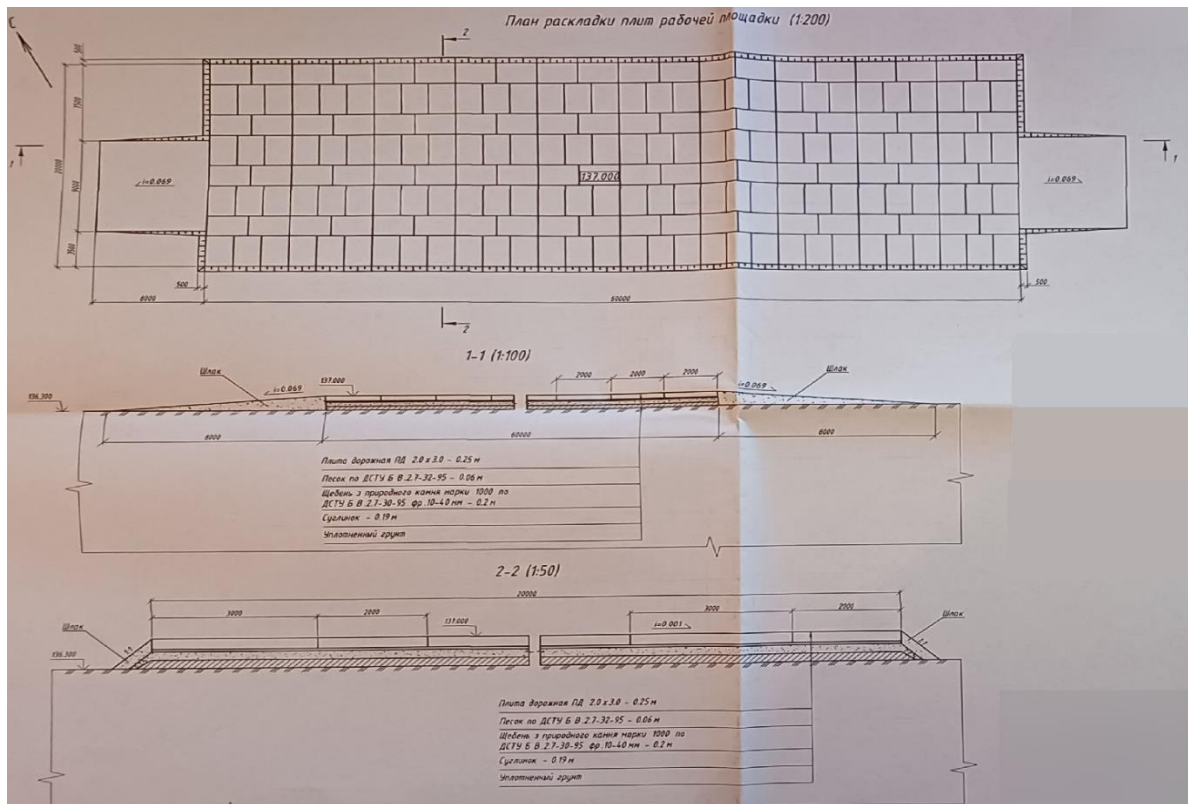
План і розрізи будівельного майданчика із схемою укладання дорожніх плиті рішення площадка
